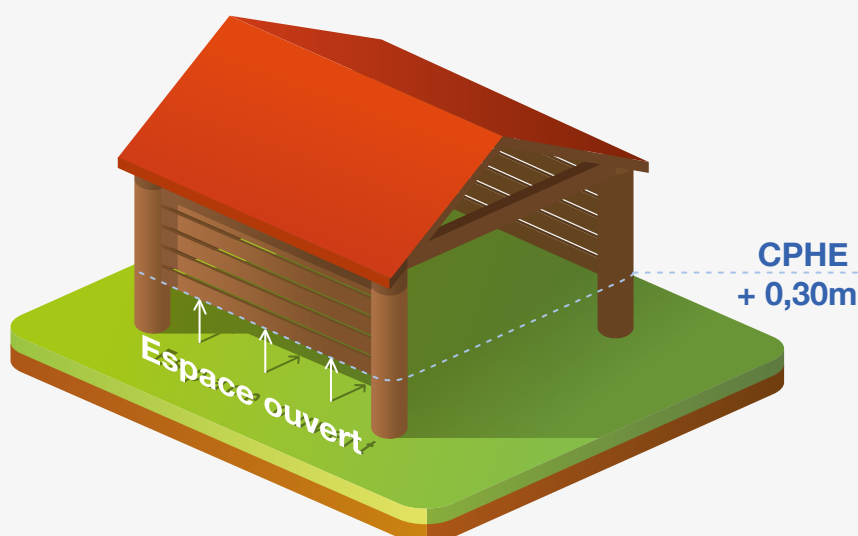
Illustration d'une construction autre qu'un bâtiment ne comportant pas de paroi sous la CPHE.
